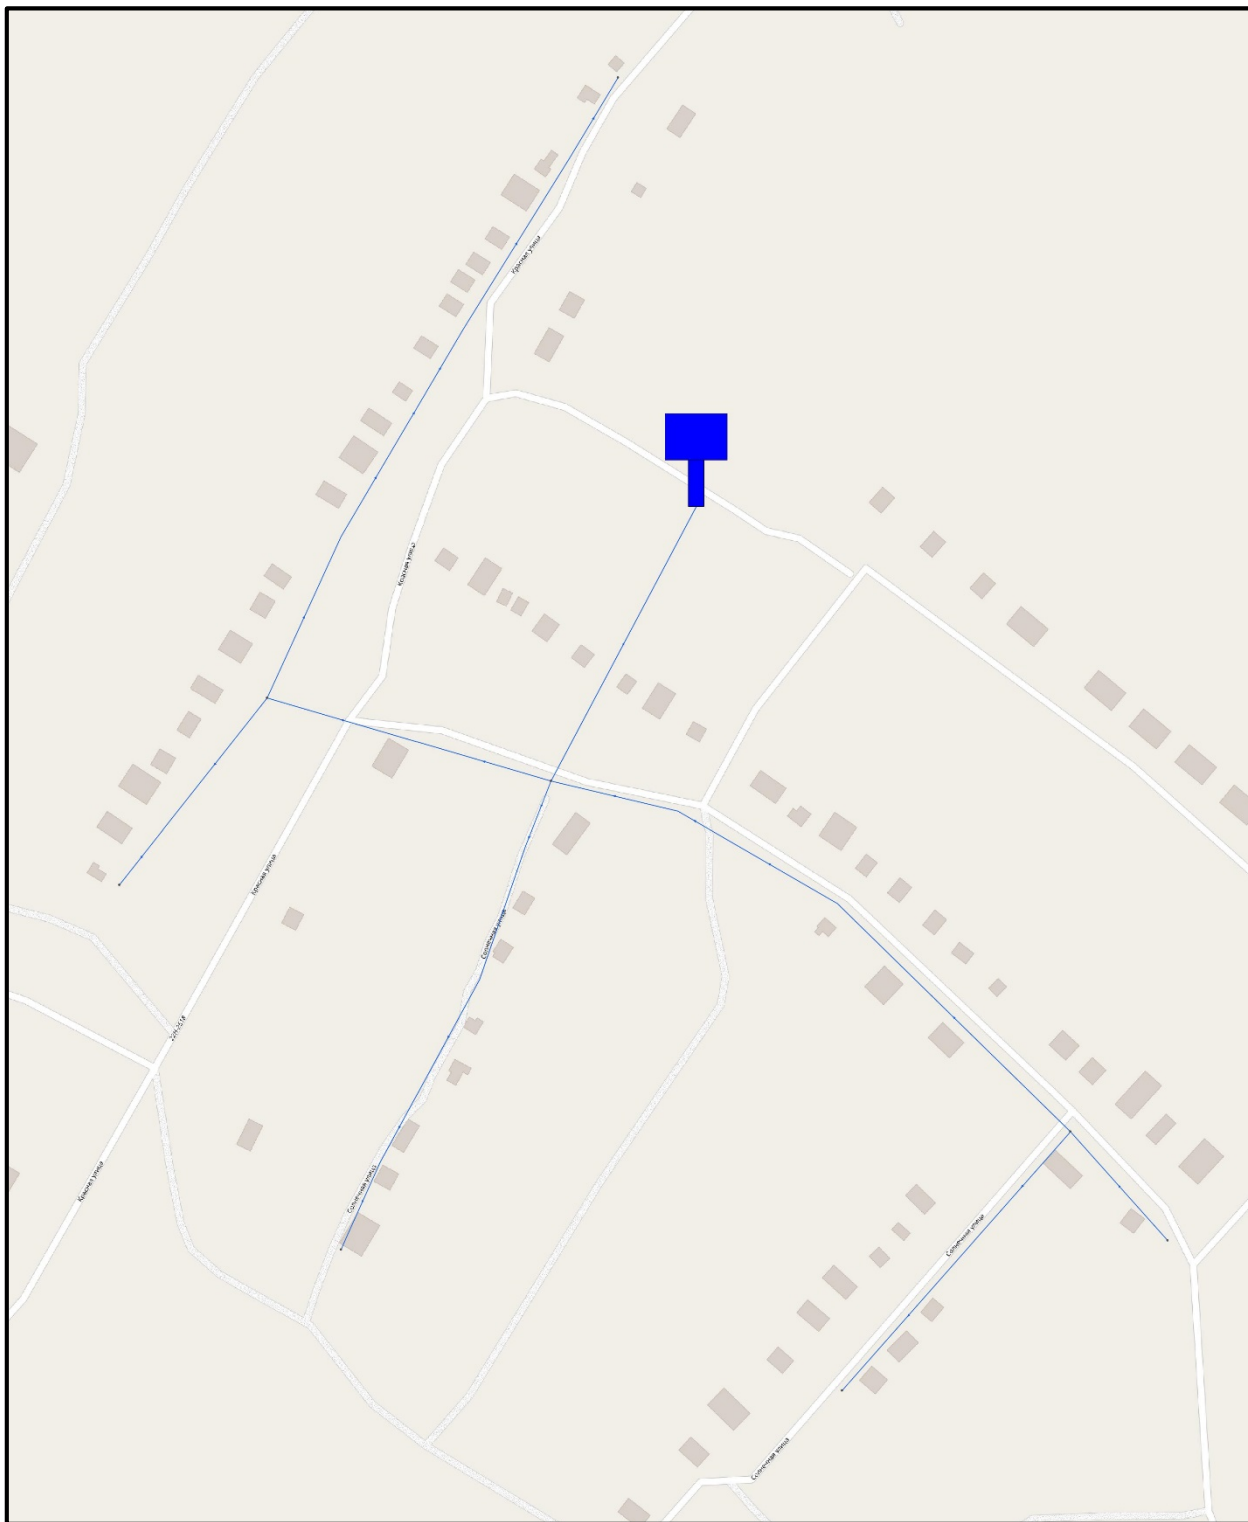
Схема водоснабжения с. Федоровка
